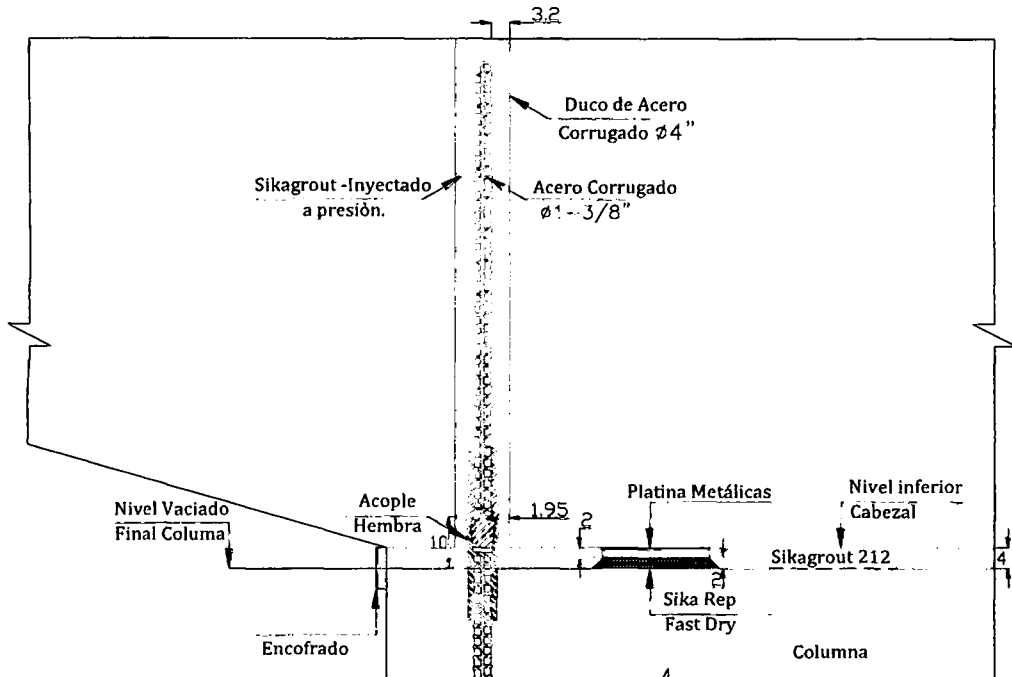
Esquema de cabezal colocado en columna y grouteado.
